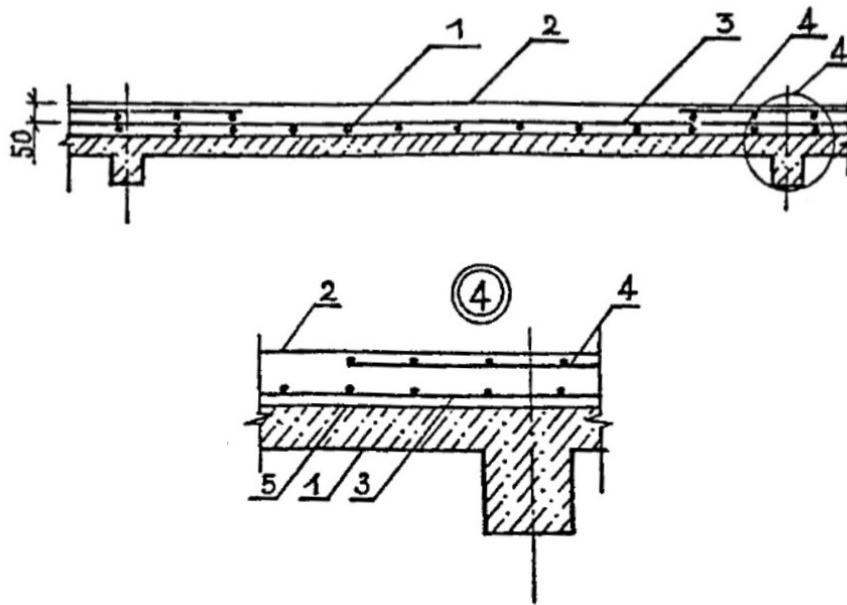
Збільшення несучої здатності плити перекриття нарощуванням зверху при недостатньому з'єднанні поверхонь: 1 – плита перекриття, яка підлягає підсиленню; 2 – шар бетону з моноліту; 3 – арматурна сітка знизу; 4 – арматурна сітка зверху, 5 – верхня площина плити, яка не має з'єднання з монолітним бетоном (промаслена, забруднена)
